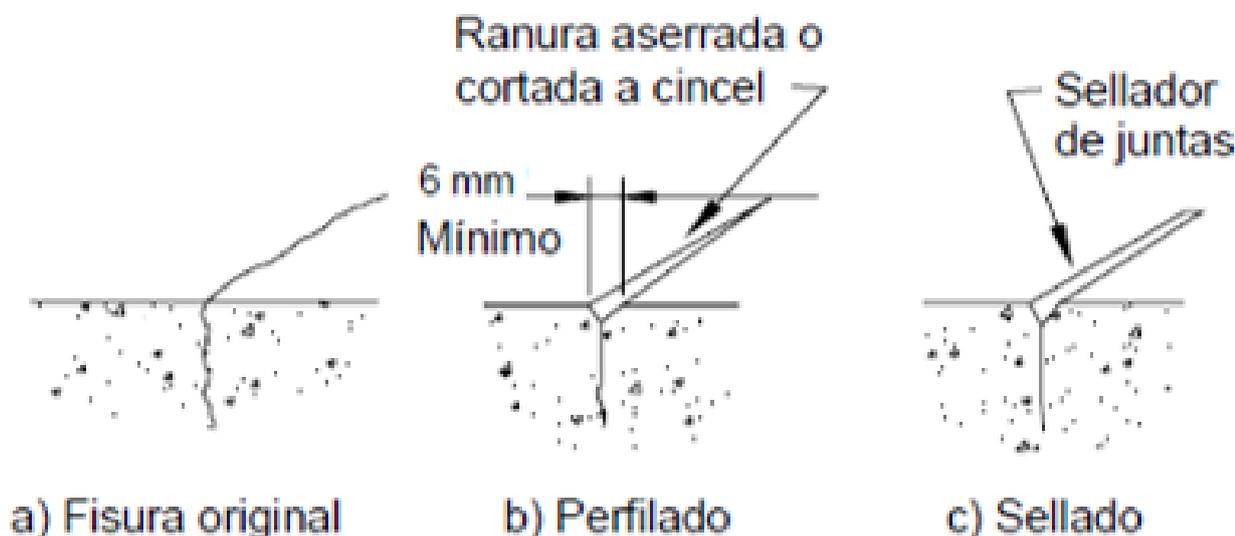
Reparación de fisura mediante perfilado y sellado.
